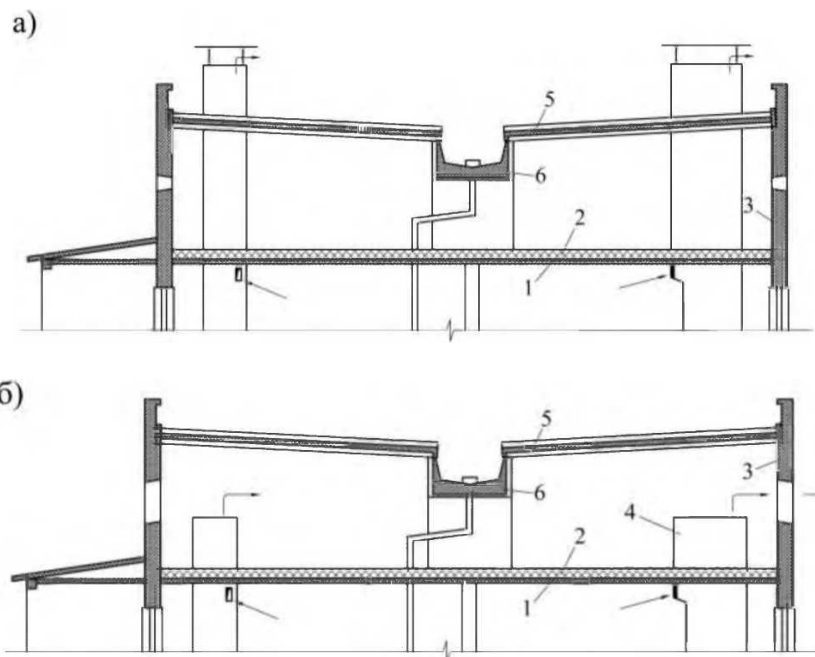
Конструктивные схемы чердачных железобетонных крыш с безрулонной кровлей: а) с холодным чердаком; б) с открытым чердаком
